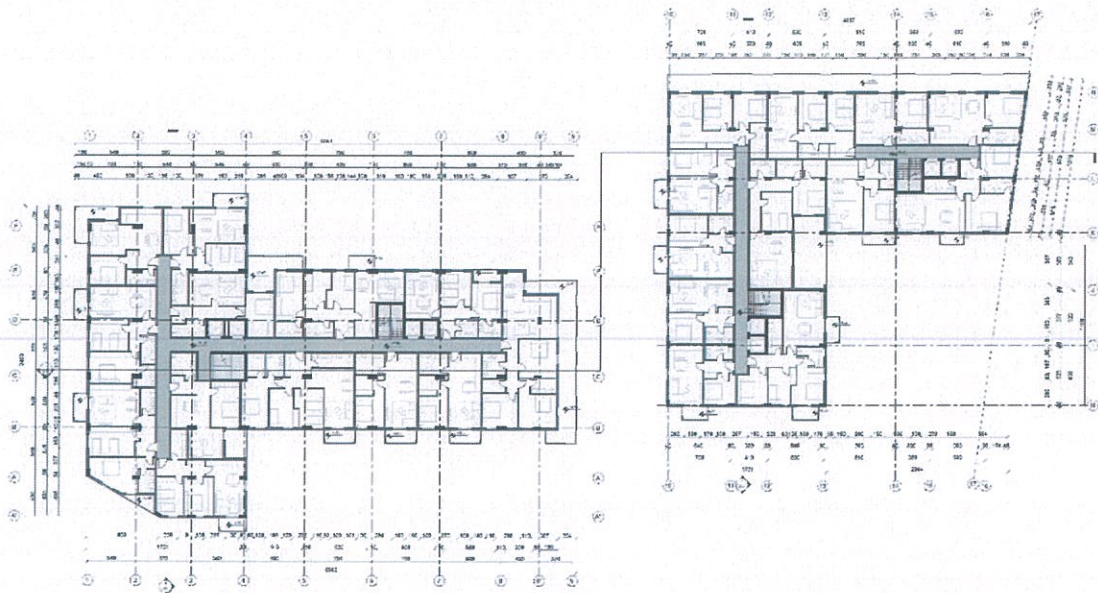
Plani I katit të tretë 2269 m² (banim)
